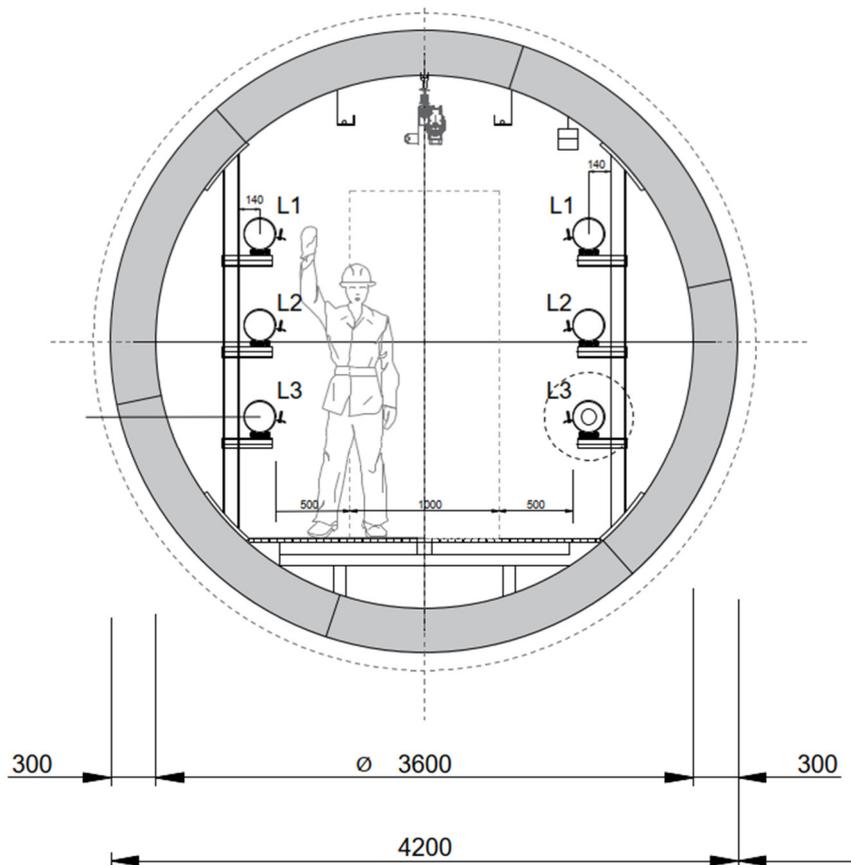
Prinzipielle Darstellung Tunnelquerschnitt
